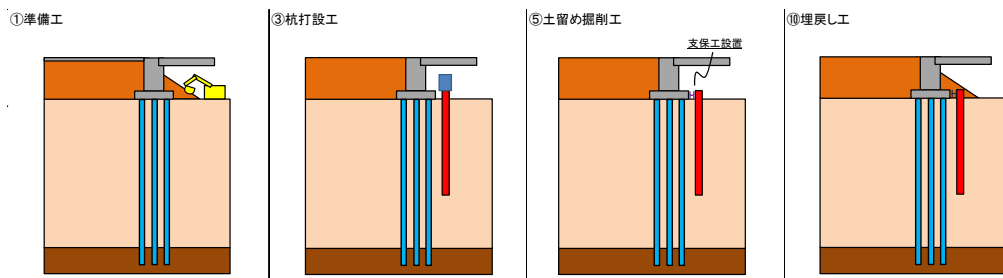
鋼管矢板壁（前面分離型）の施工手順
